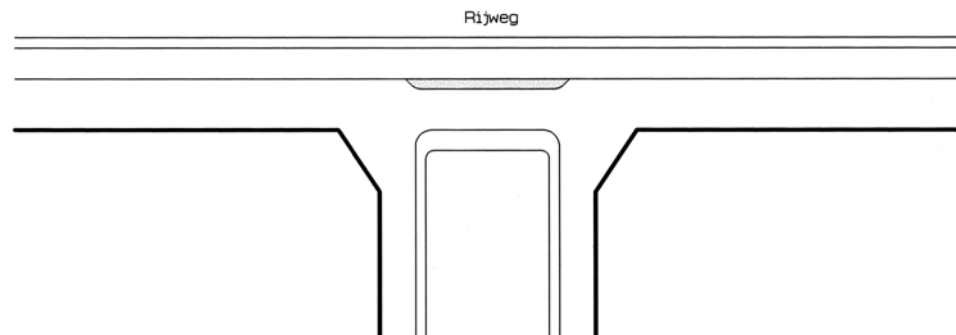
Doortrekking van het voetpad bij een uitritconstructie
